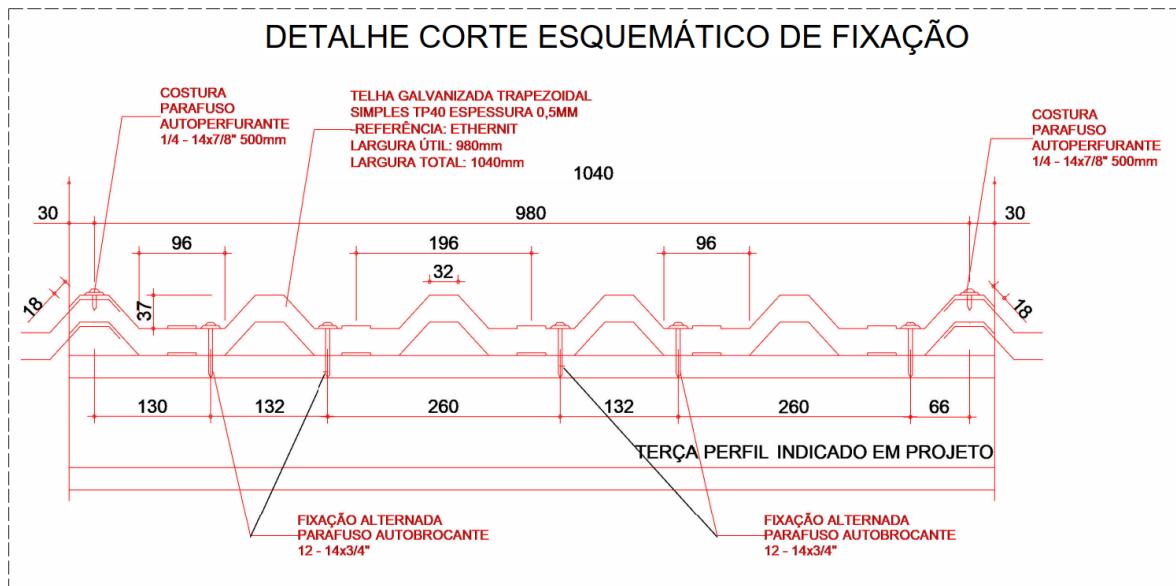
Corte Esquemático – Detalhe genérico da fixação das telhas
